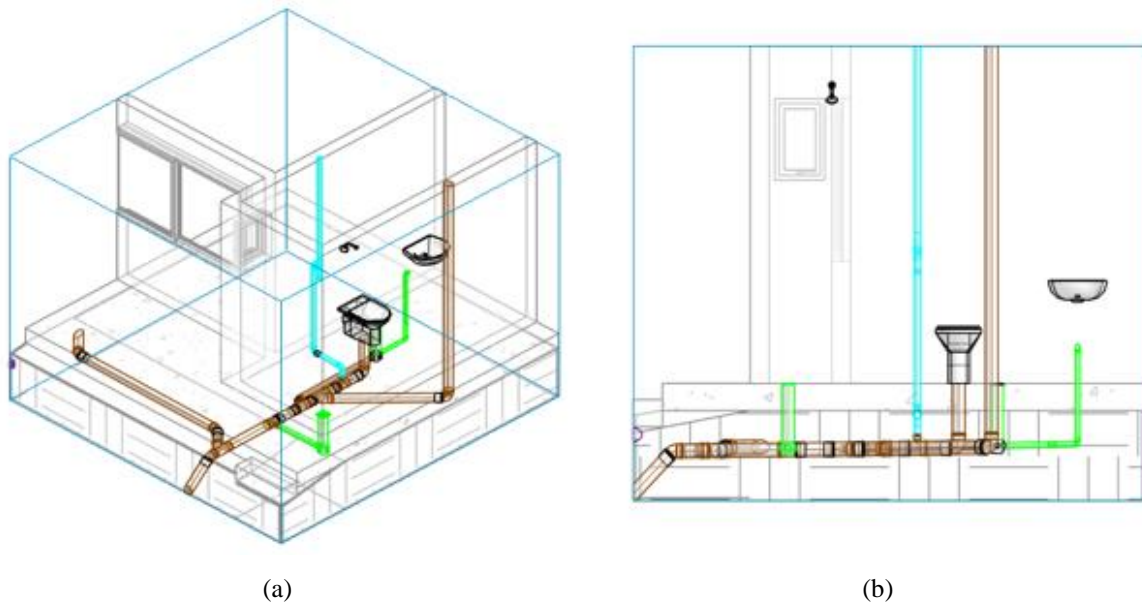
Planta baixa do esgoto do banheiro do pavimento térreo.
